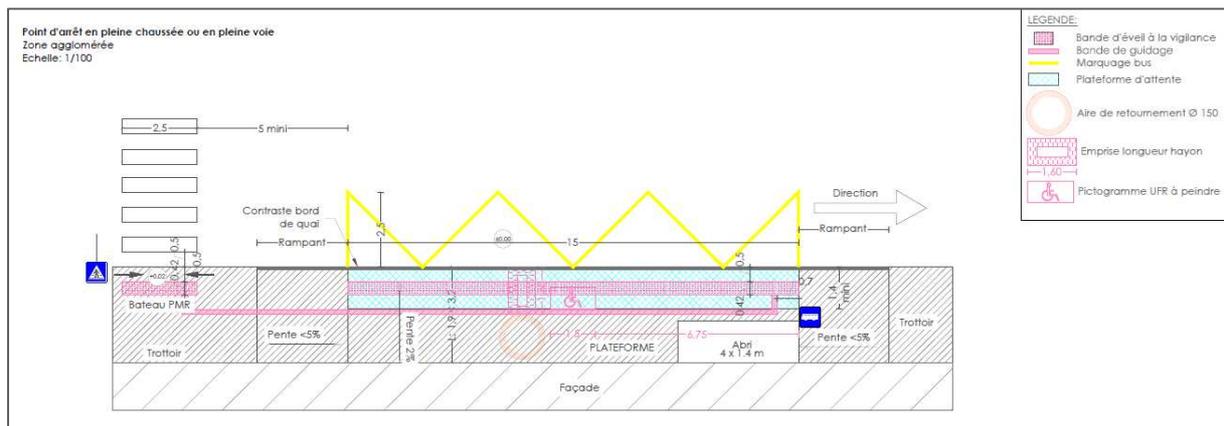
Exemple d'un arrêt routier type situé en pleine voie
